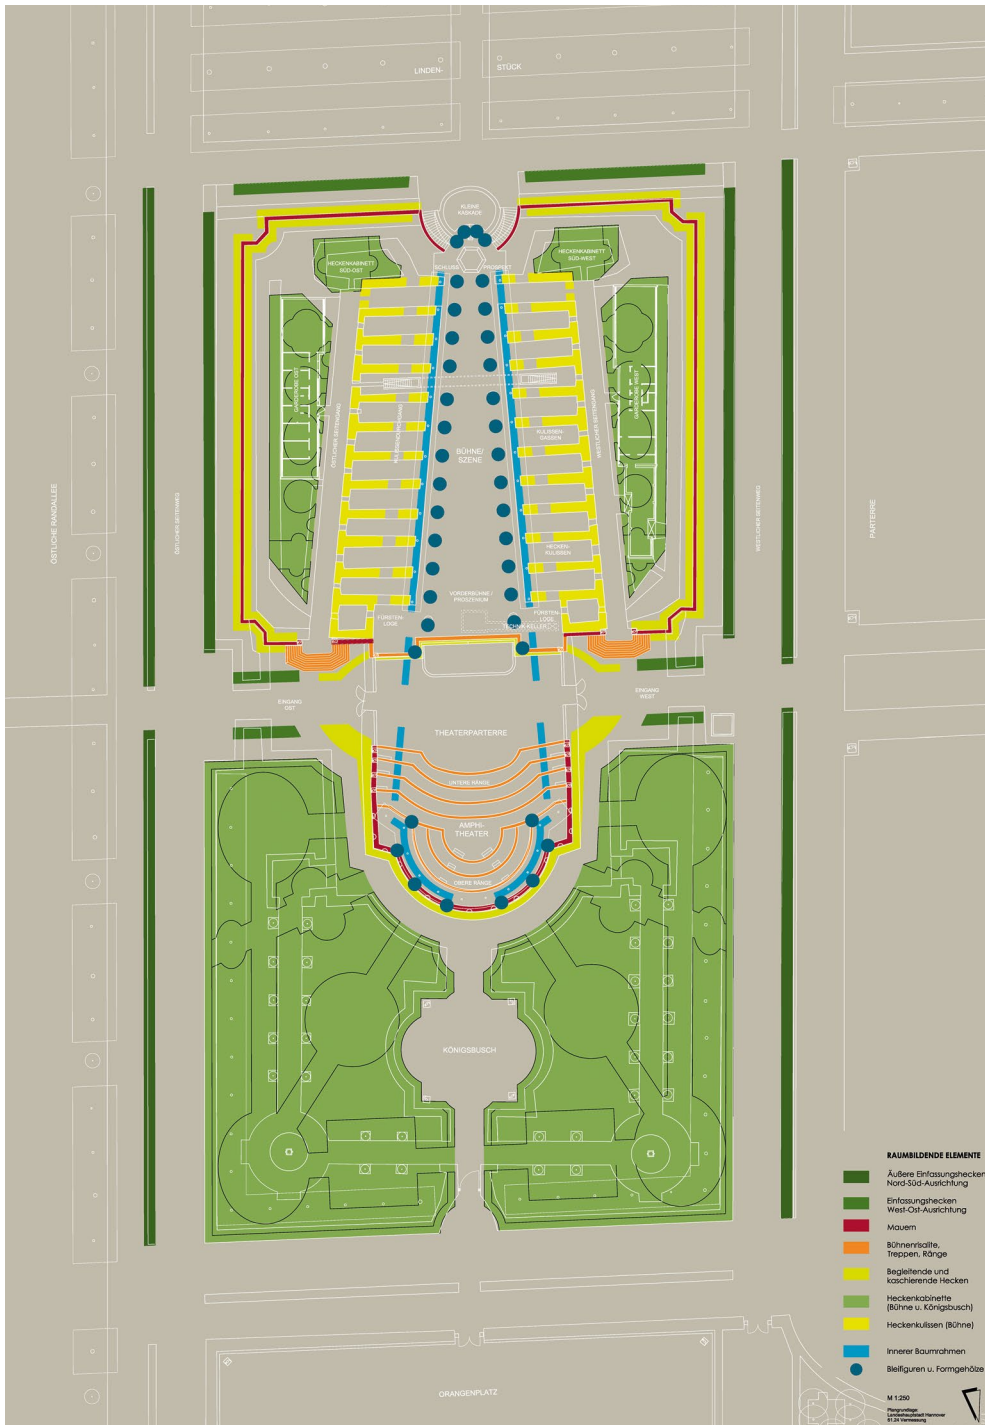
Plan Raumbildende Elemente Theaterboskett Hannover-Herrenhausen.
